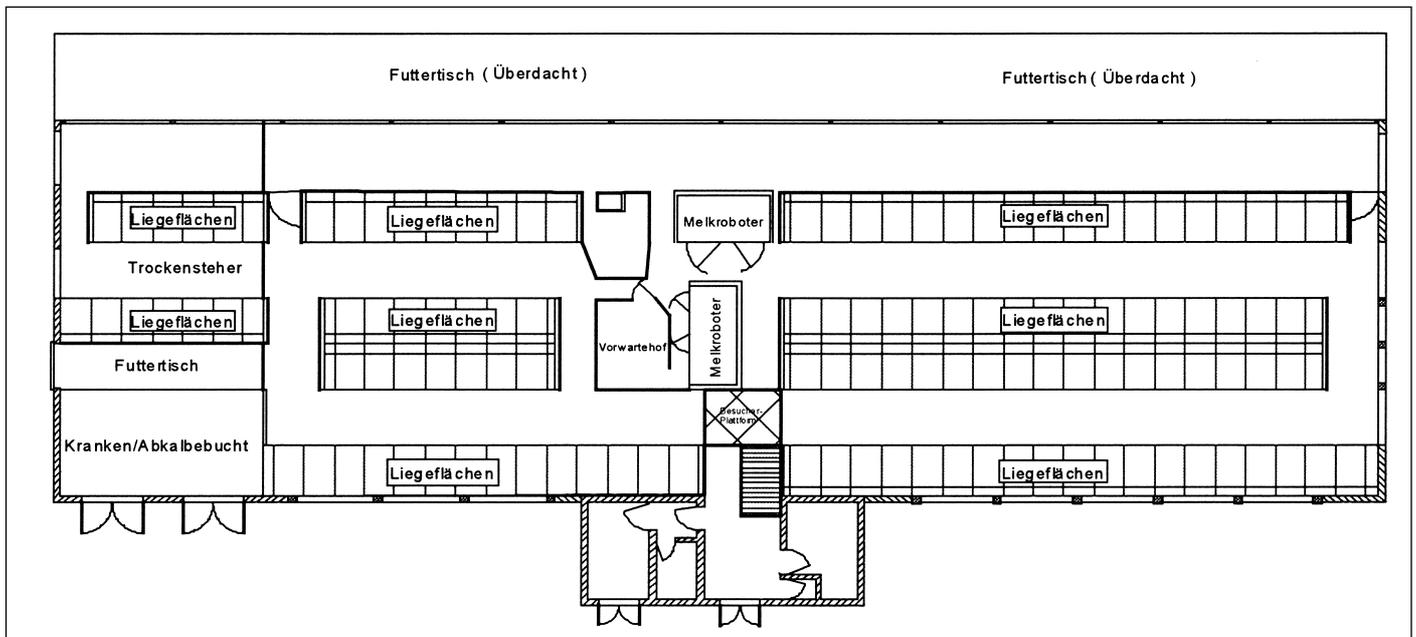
Grundriss des Offenfrontstalles in Groß-Kreutz
